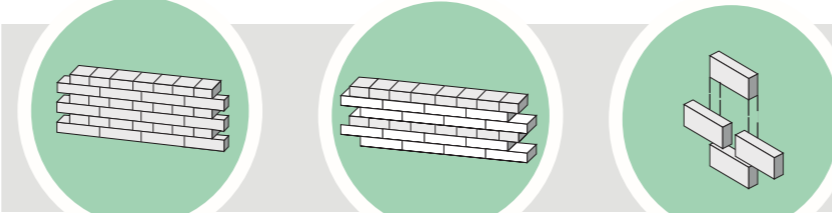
Especificaciones de cada tipología de mampostería en ladrillo. Adaptado de (Todo sobre arquitectura, s.f.)
